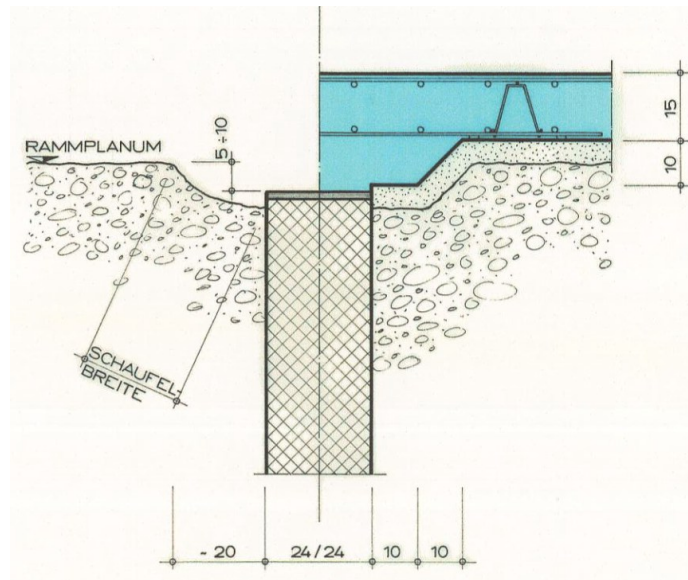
Detail Pfahlkopf bestehende Betonplatte
